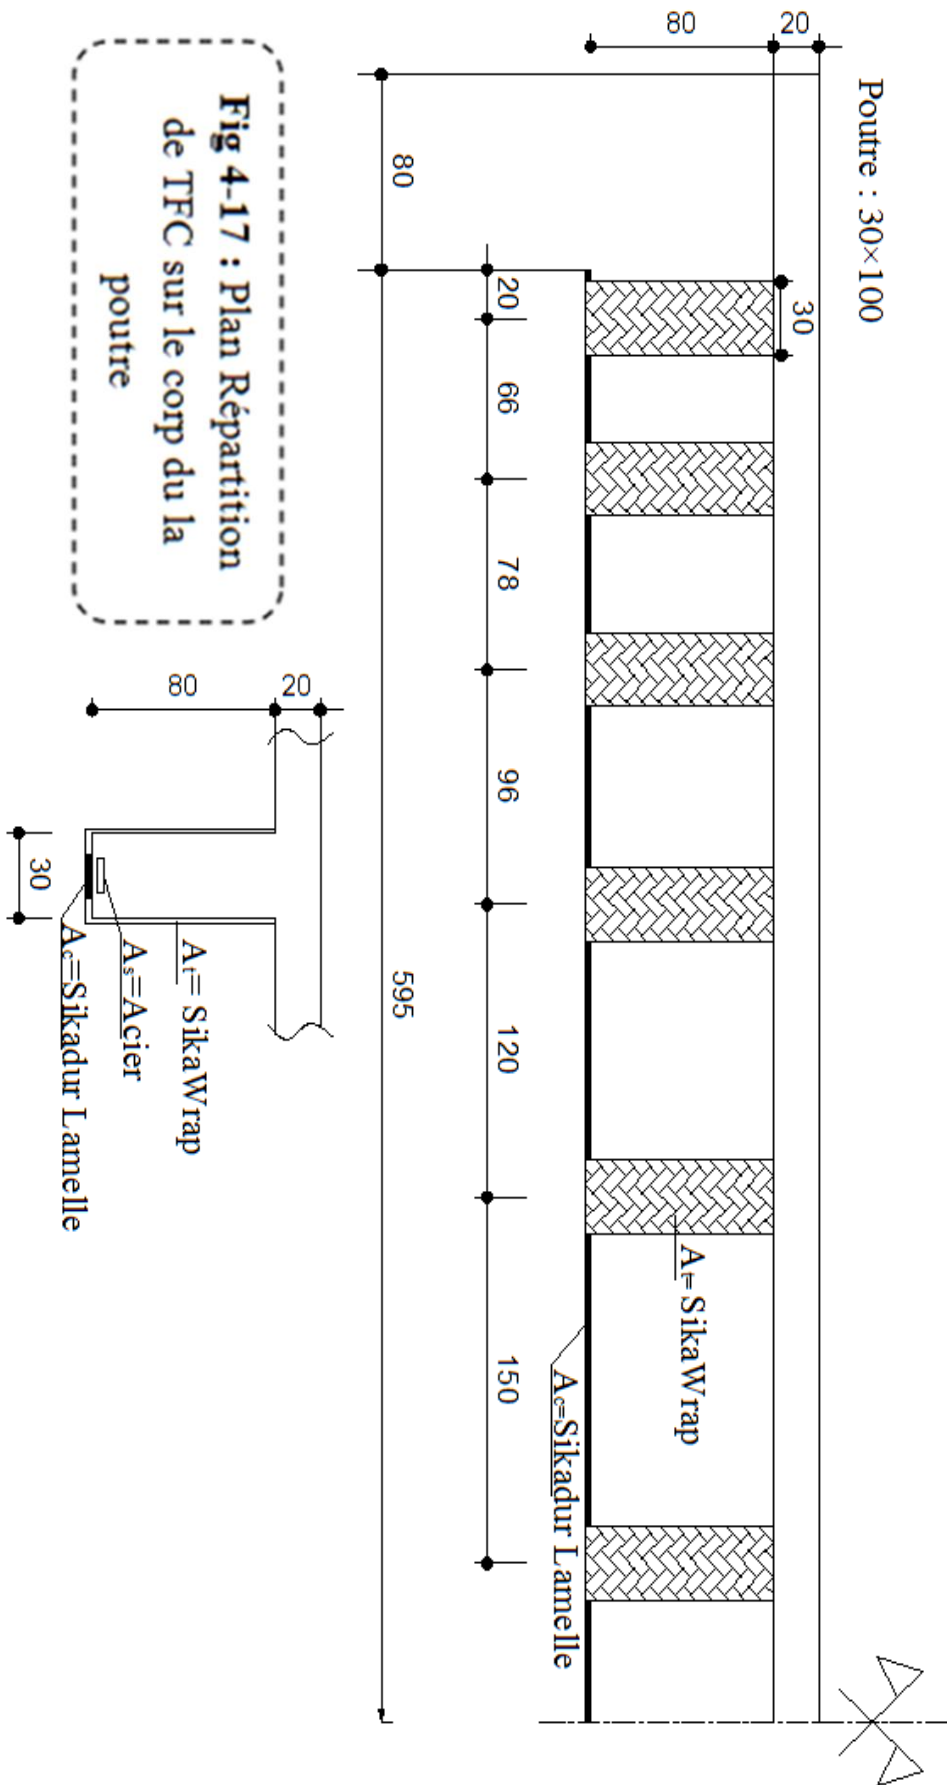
Plan Répartition de TFC sur le corps du la poutre
